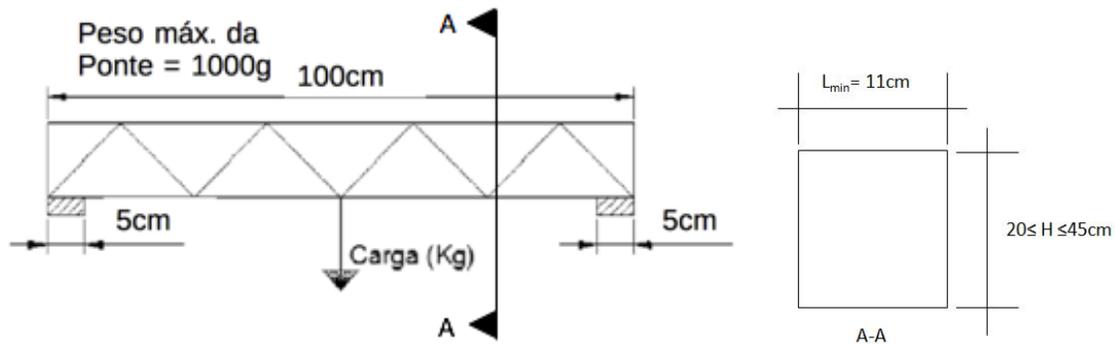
Dimensões da ponte e ponto de aplicação de carga
